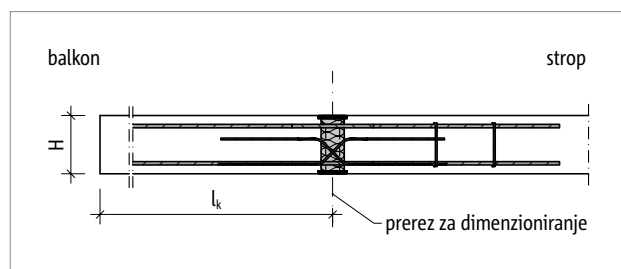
Schöck Isokorb® T tip DP: statičen sistem
